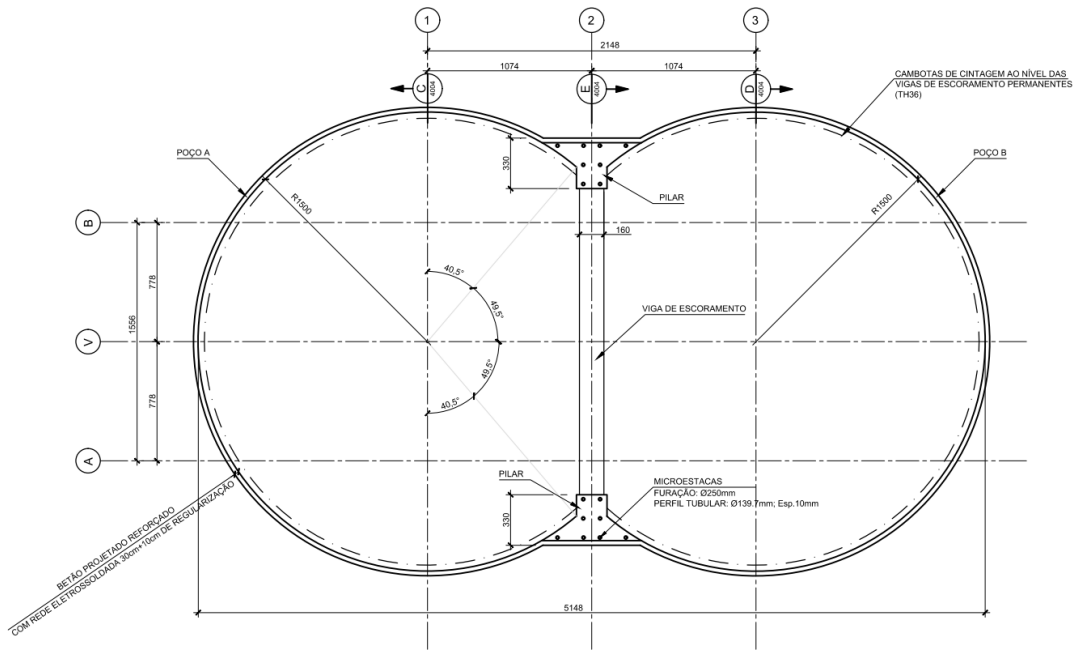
Planta do Poço Central (Suporte Primário)
